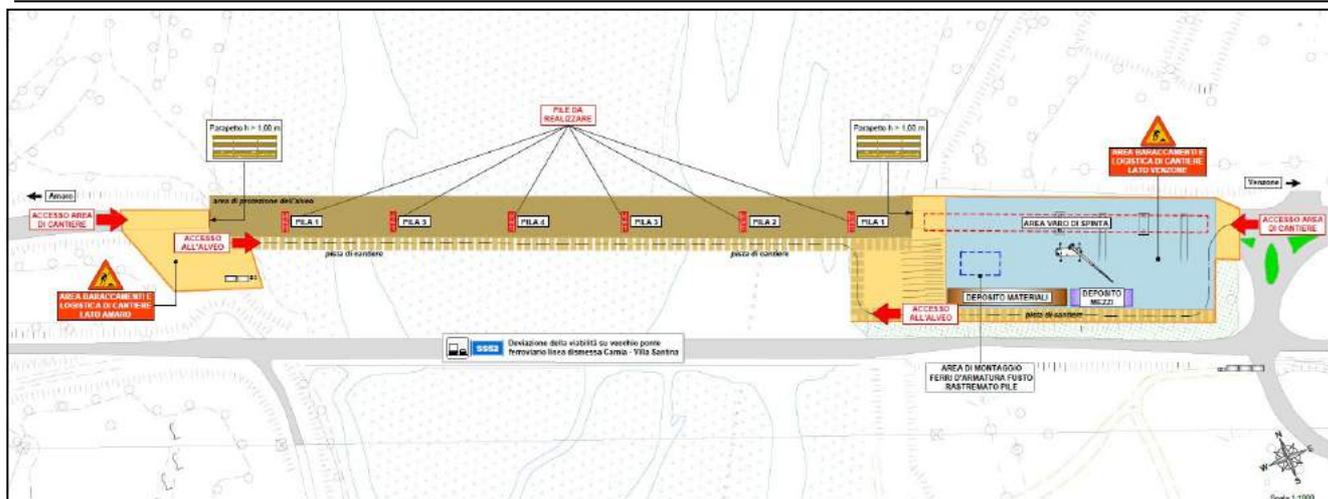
Cantiere fisso: fasi realizzazione pile ed impalcato.
